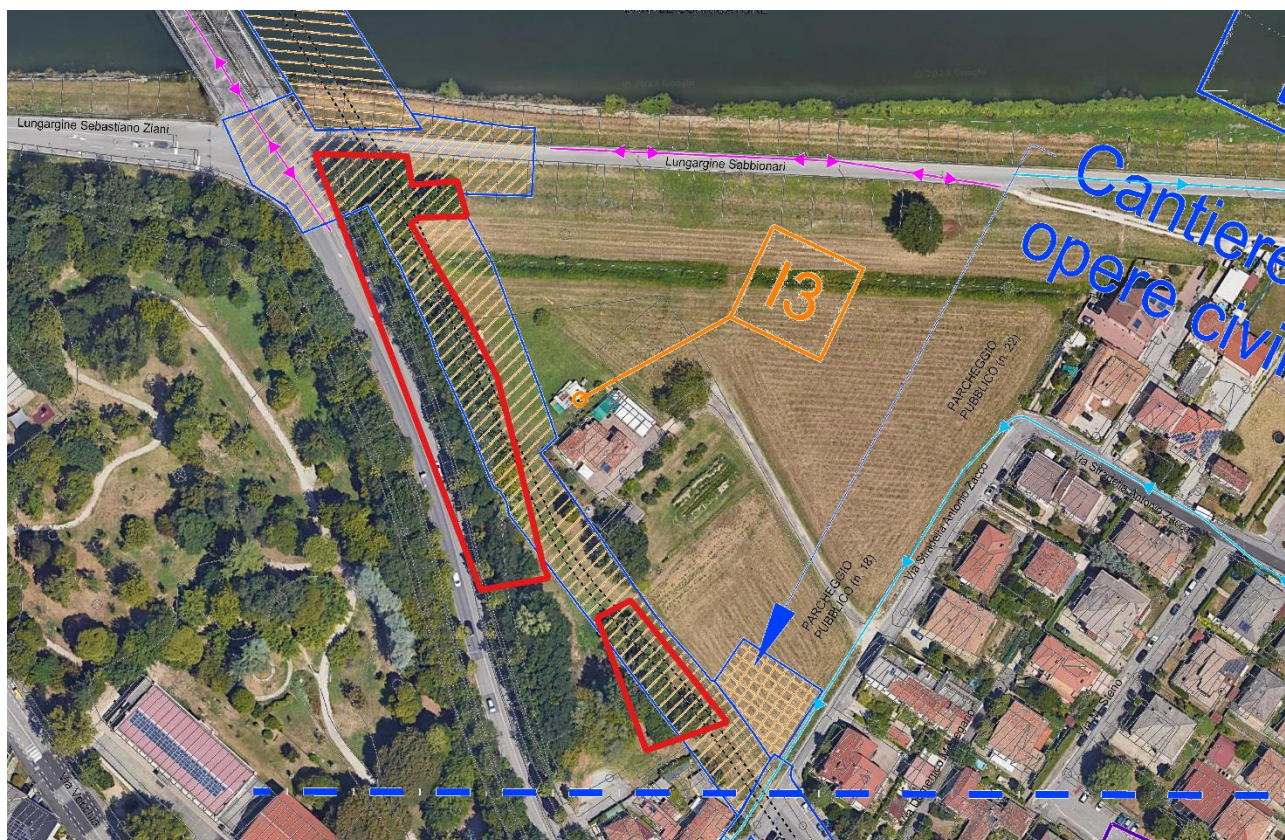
sovrapposizione dell'area da eliminare sulla tavola di progetto e ortofoto
